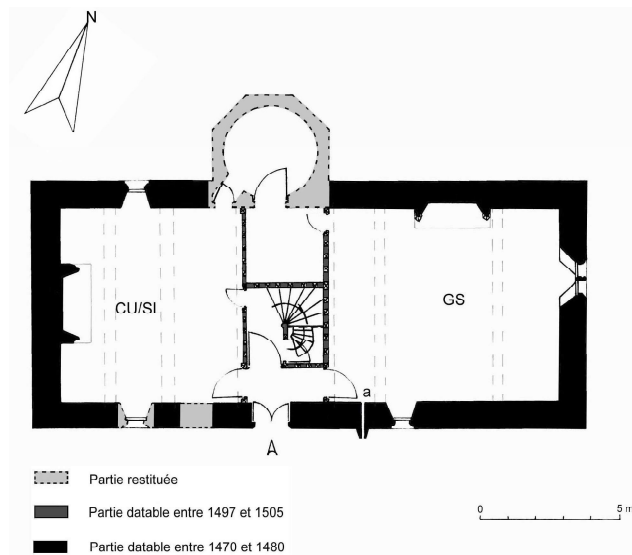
Perriers. Plan restitué du rez-de-chaussée entre 1497 et 1505.
